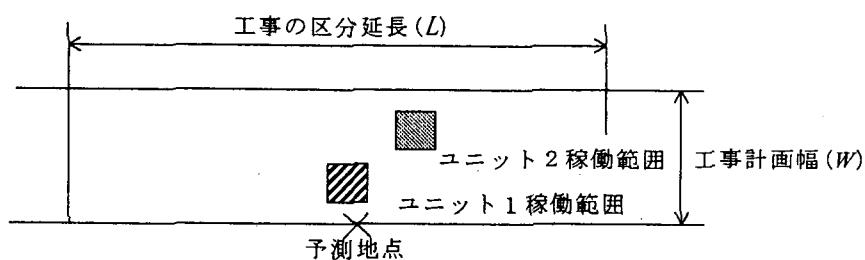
施工範囲が特定されない場合の施工範囲の配置例
